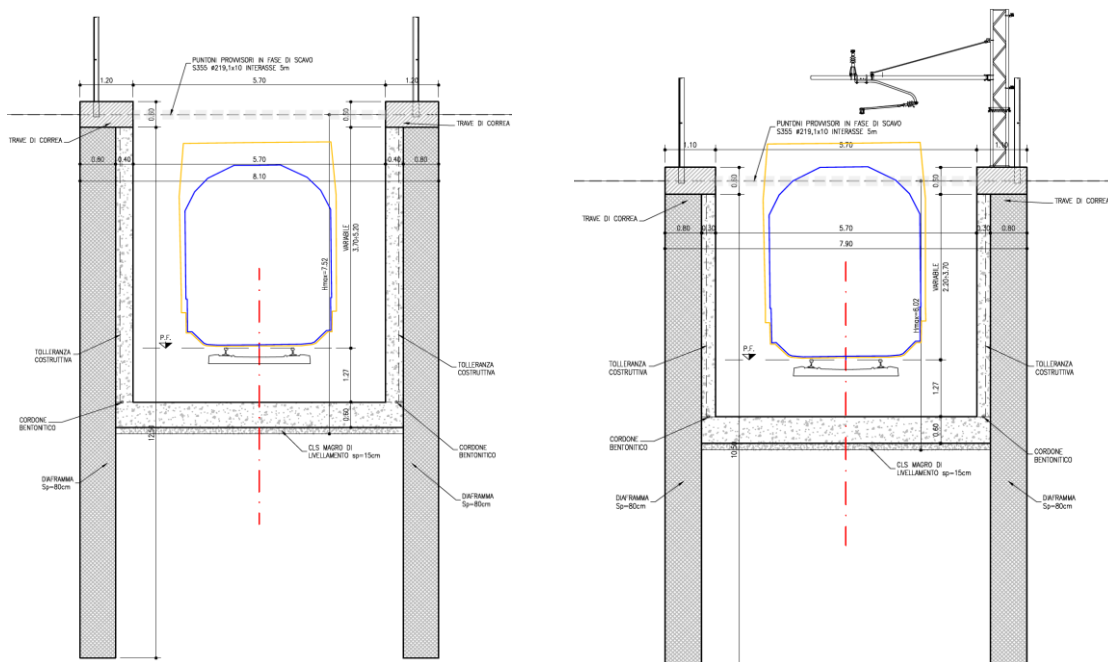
Scavo con diaframmi – sezione TIPO 7a \ 7b
